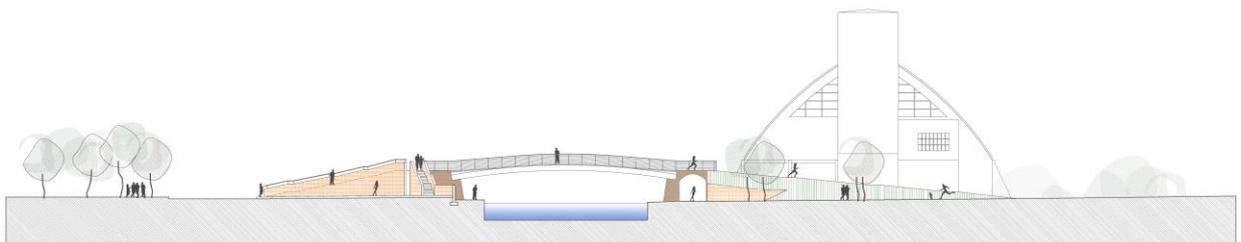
Schema degli interventi previsti nel progetto esecutivo - Sezione
